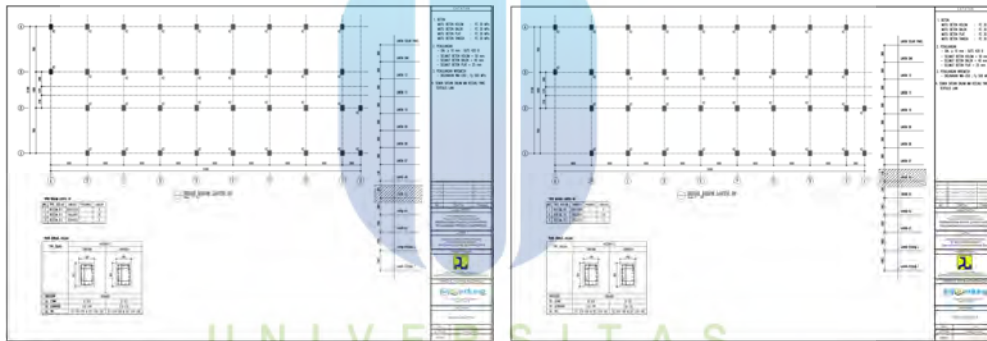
6 Detail struktur balok lantai 12 dan Dak Atap
